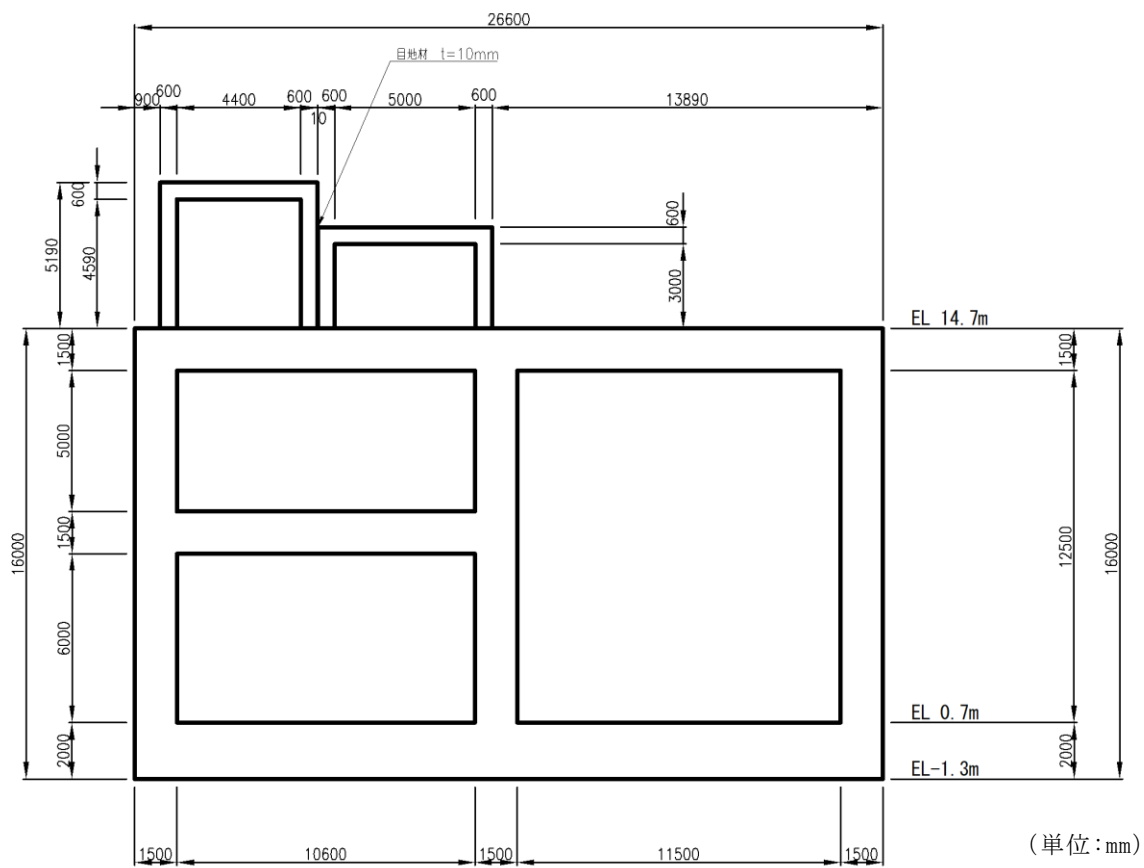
低圧原子炉代替注水ポンプ格納槽 断面図 (C-C断面)
